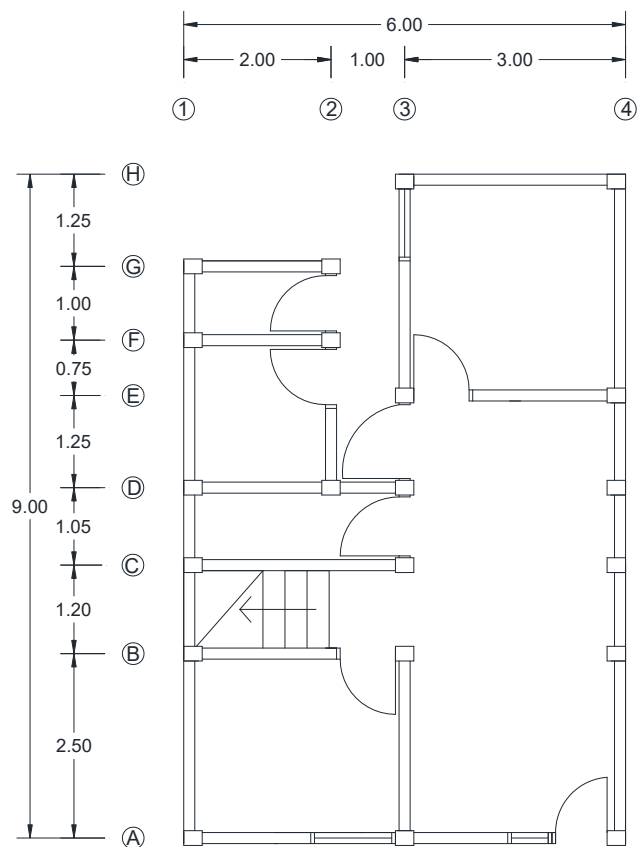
Denah rumah tinggal tipe 45 lantai 2
